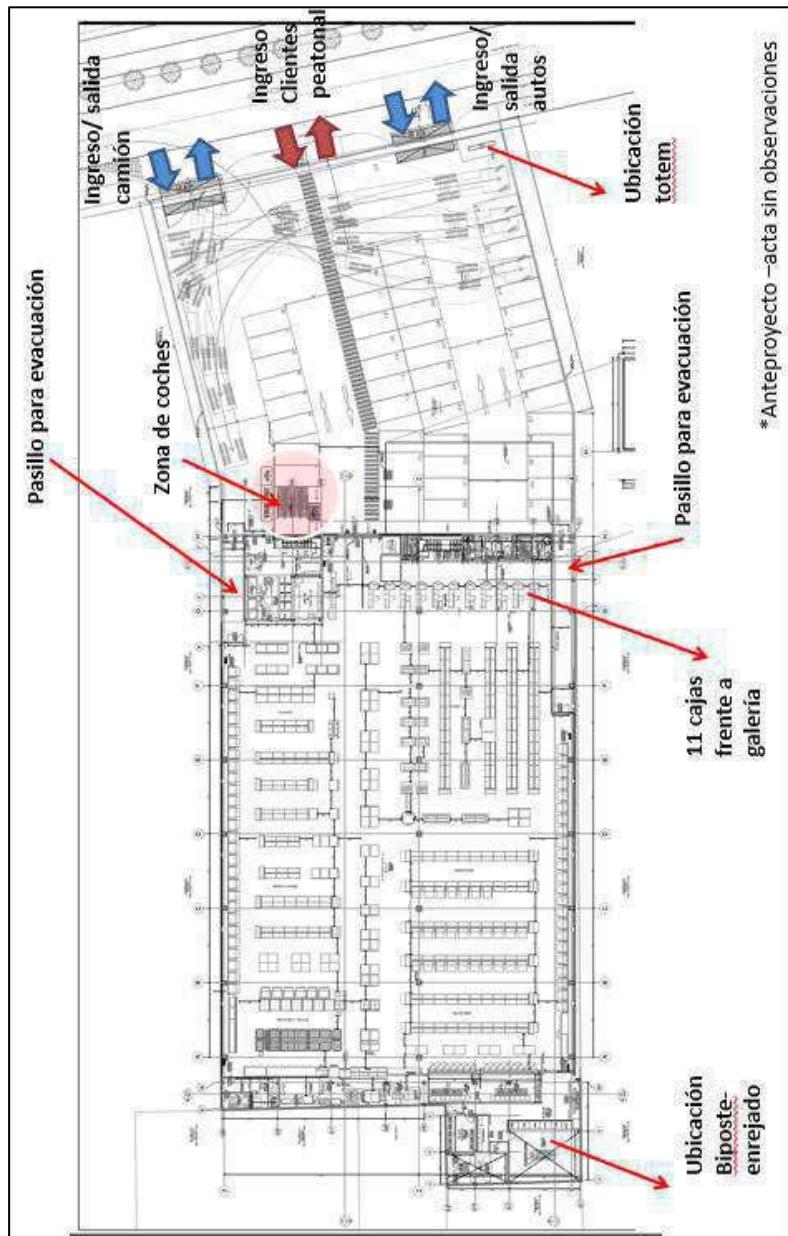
Primera propuesta de Proyecto con una sala de ventas de 1830.04 m²
